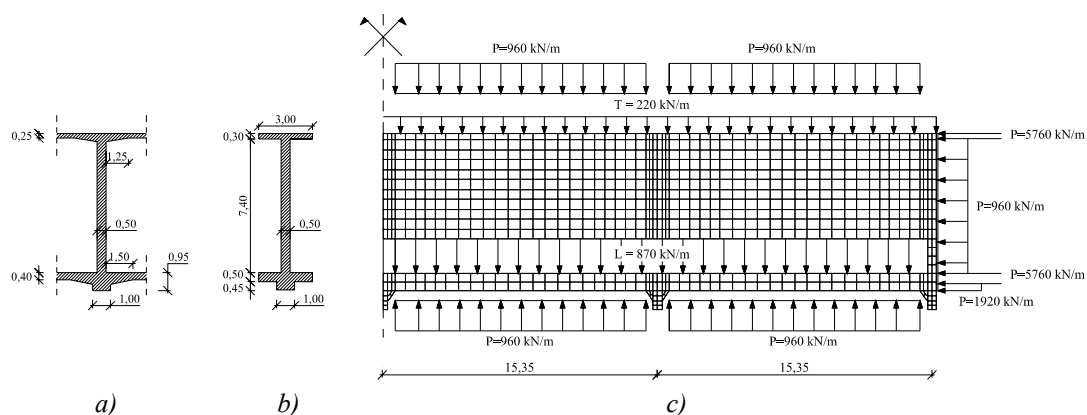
Análise bidimensional das vigas-parede: a) Corte transversal; b) Modelação das espessuras; c) Malha de elementos finitos com o esquema das cargas aplicadas (L – peso do líquido e da laje de fundo, T – peso das terras e da laje de cobertura; P – carga equivalente ao pré-esforço).
